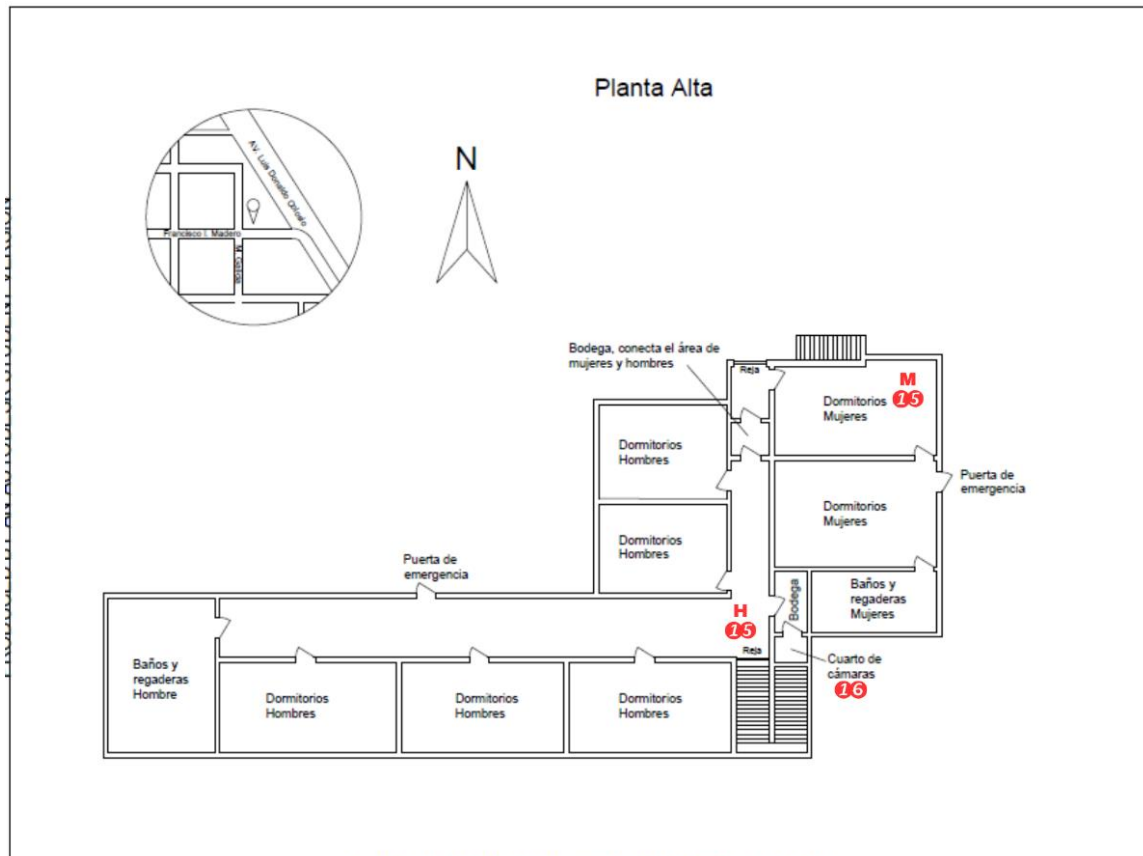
Planta Alta CMN, reconstrucción propia. Plano: Guillermo Olvera
